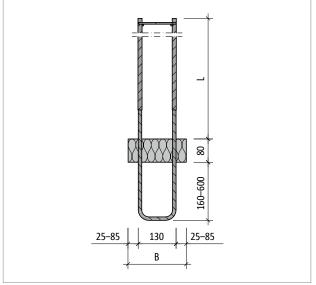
Schöck Sconnex® type W-T2-BW : coupe A-A du produit
